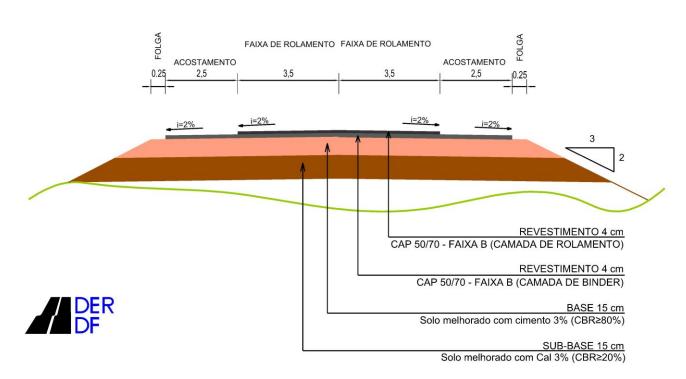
Seção Transversal Tipo da Pavimentação da DF-285
